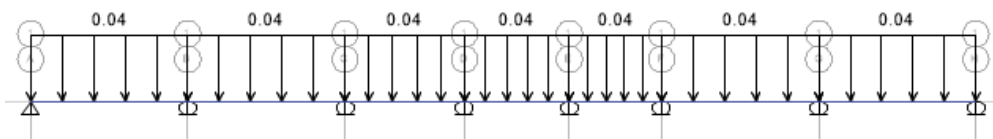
Carga de tabiquería y piso terminado en vigueta de losa aligerada
